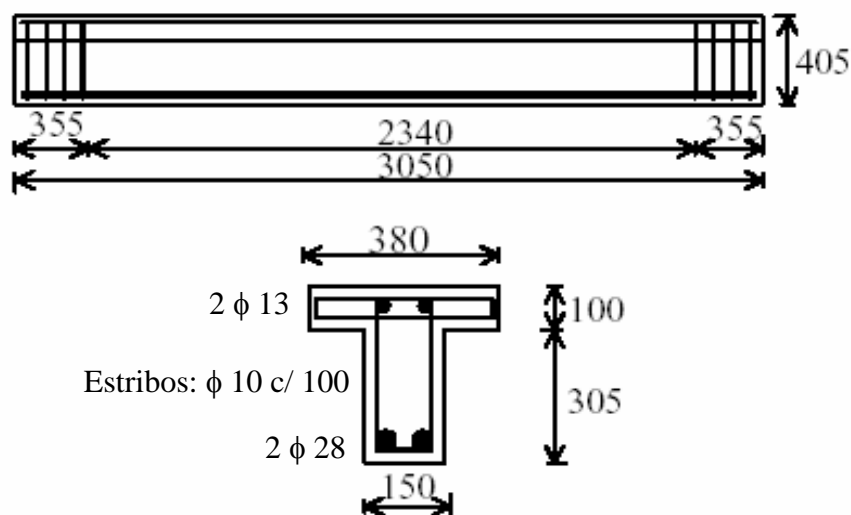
Dimensões e detalhamento das vigas (dimensões em mm); adaptada de Khalifa *et al.* (1999).
